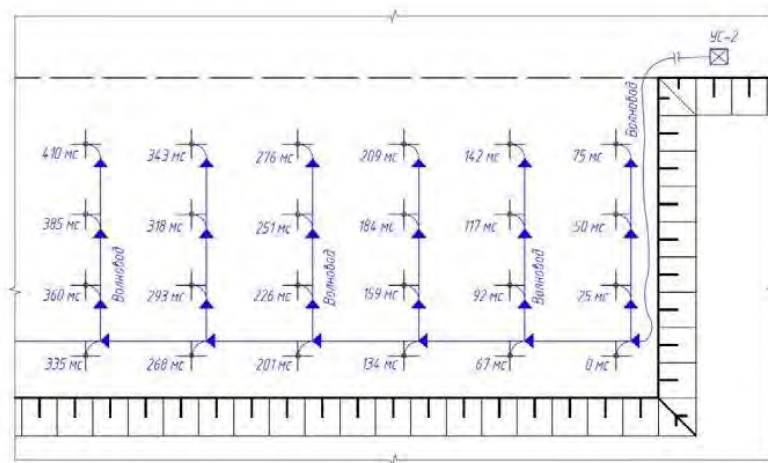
Поперечная схема монтажа с применением поверхностных волноводов
